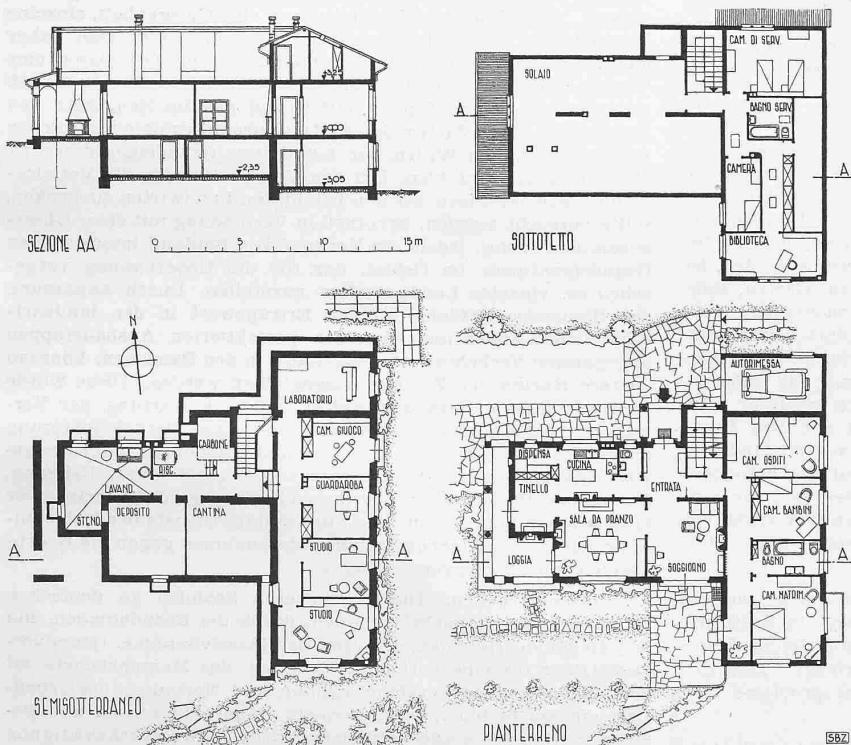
Grundrisse von Unter-, Erd- und Obergeschoss mit Schnitt. — 1:400
